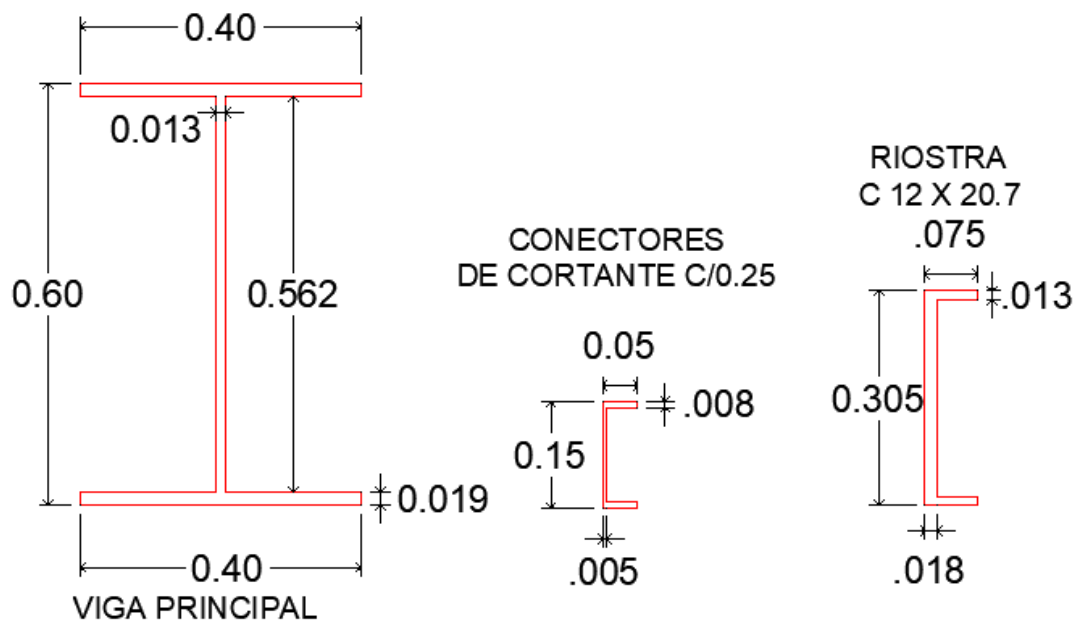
sección transversal de los elementos metálicos del puente con vigas metálicas de 12 metros. (ver anexo 04 página 03)
